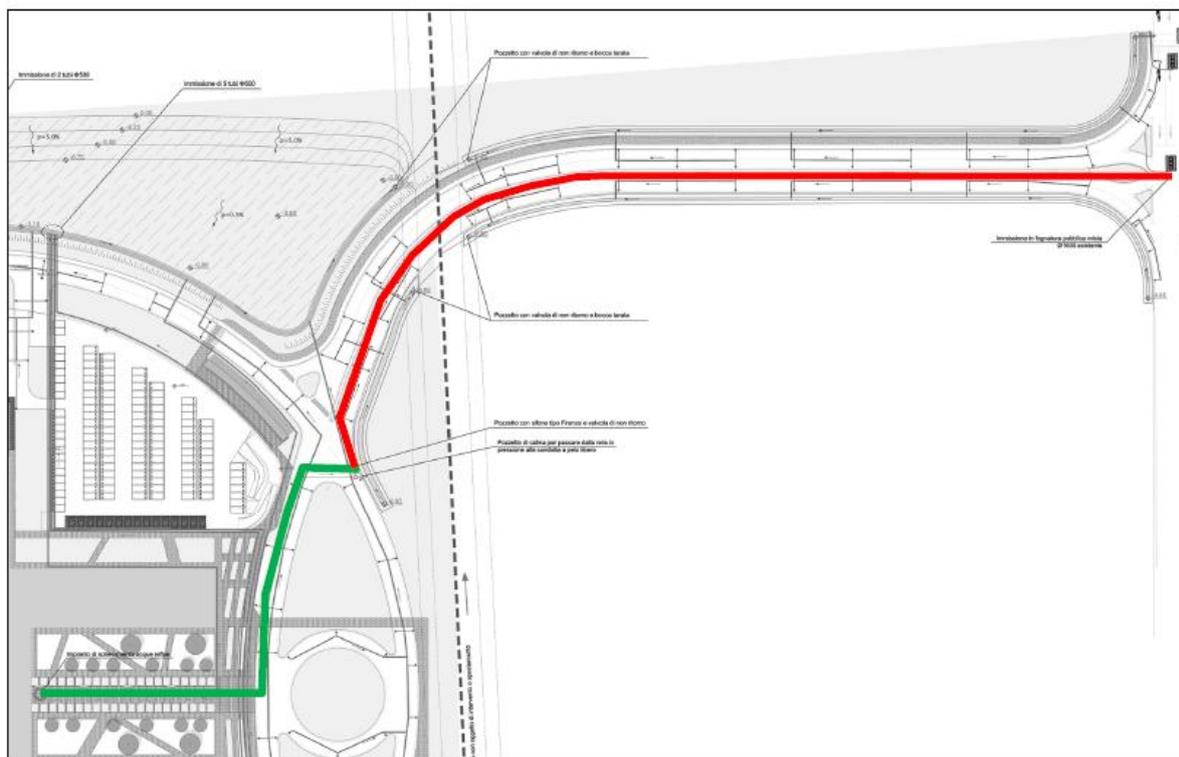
Schema della rete nera dall'impianto di sollevamento alla fognatura pubblica (in verde il tratto in pressione e in rosso il tratto a pelo libero)
